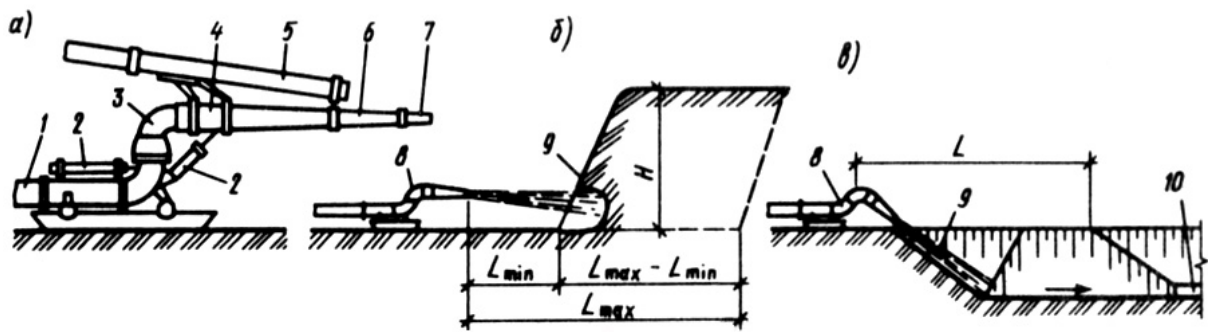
Гидромониторный способ разработки грунта: а) схема гидромонитора; б) встречный забой; в) попутный забой; 1 – водовод; 2 – гидроцилиндры управления; 3, 4 – шарнирное сочленение ствола с водоводом; 5 – рычаг; 6 – ствол; 7 – насадка ствола; 8 – гидромонитор; 9 – фронт забоя; 10 – канава отвода пульпы
